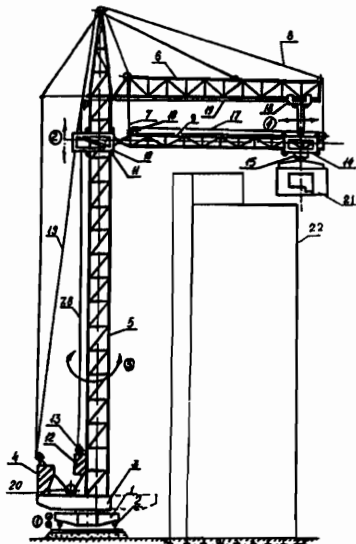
Башенный кран-манипулятор с подвижным подстрелком: 1 - платформа; 2 - ходовая часть; 3 - платформа поворотная; 4 - противовес; 5 - башня; 6 - стрела; 7, 8 - трос; 9 - подстрелок; 10 - обойма; 11 - опоры качения; 12 - подвижный противовес; 13 - лебедка; 14 - грузовая тележка; 15 - рабочий орган; 16, 17 - лебедка и канат перемещения грузовой тележки; 18 - грузовая тележка; 19 - канат перемещения тележки; 20 - грузовая лебедка; 21 - монтируемая конструкция; 22 - здание
